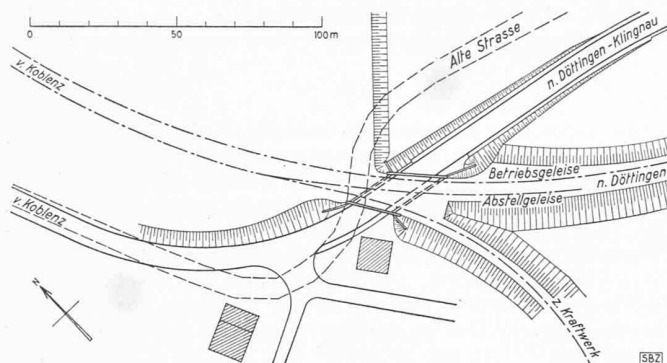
Strassenunterführung bei Koblenz. Lageplan 1:2500
